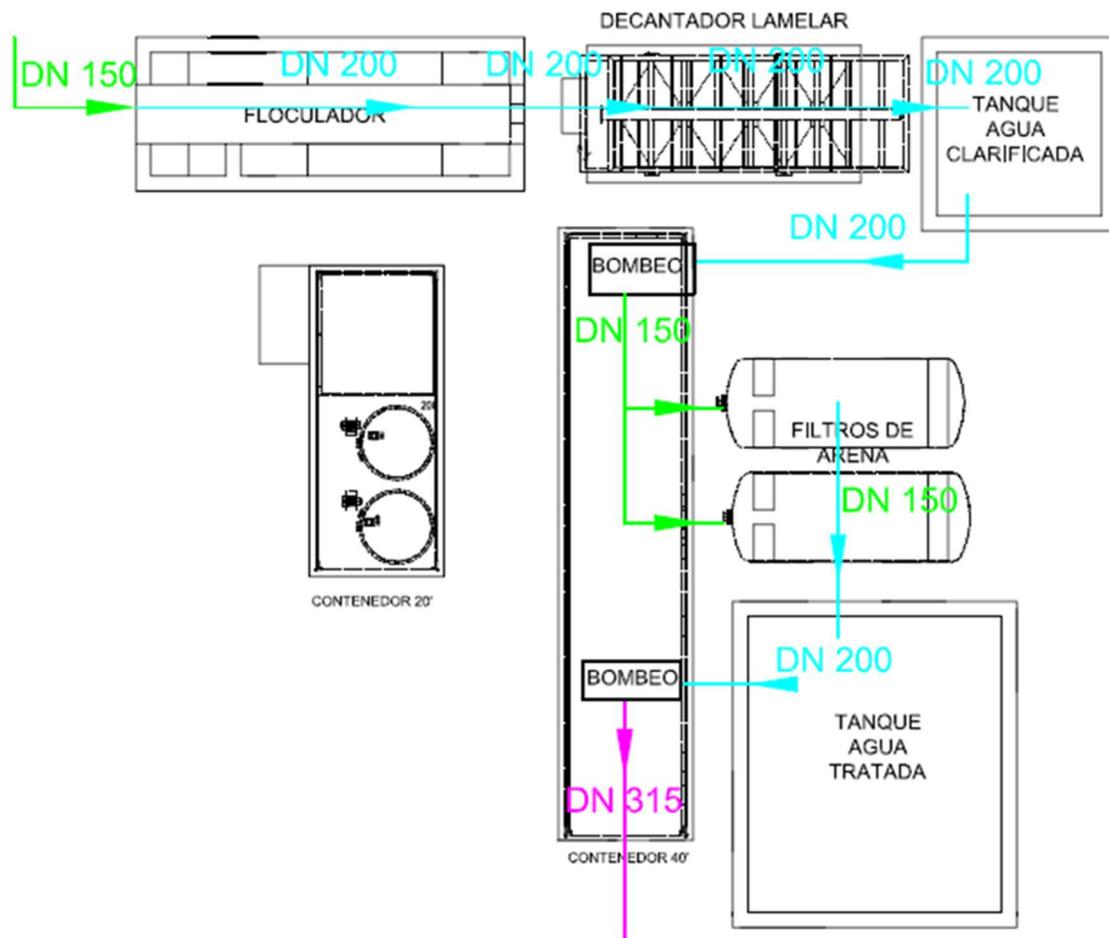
Esquema de distribución de las tuberías en la planta.
